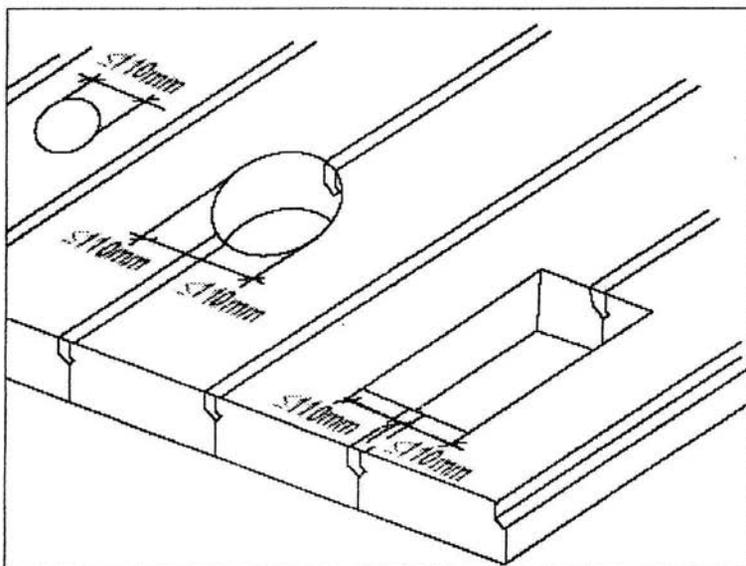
En la figura se ilustra el ancho y diámetro máximo de perforación de huecos en los paneles de losa de concreto celular, la cual no debe exceder de 110 mm de ancho o diámetro.
